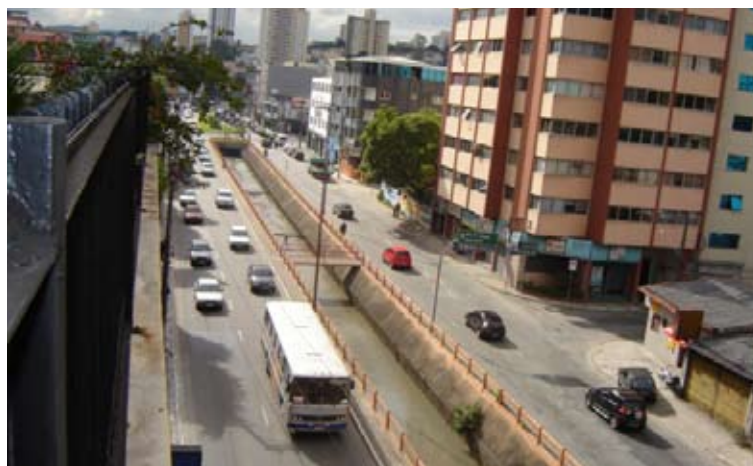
a – Foto de córrego canalizado na região central de Guarulhos, Av. Tirdentes.
